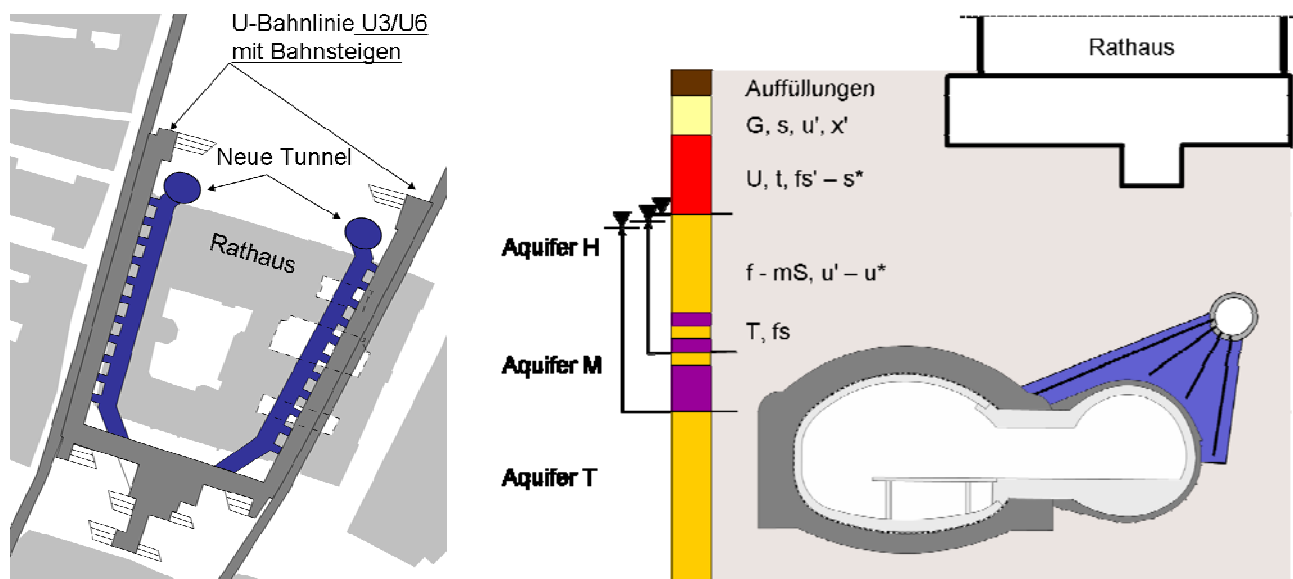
a u. b: Lage und Schnitt zum Bauvorhaben Bahnsteigerweiterung der U6 in München
